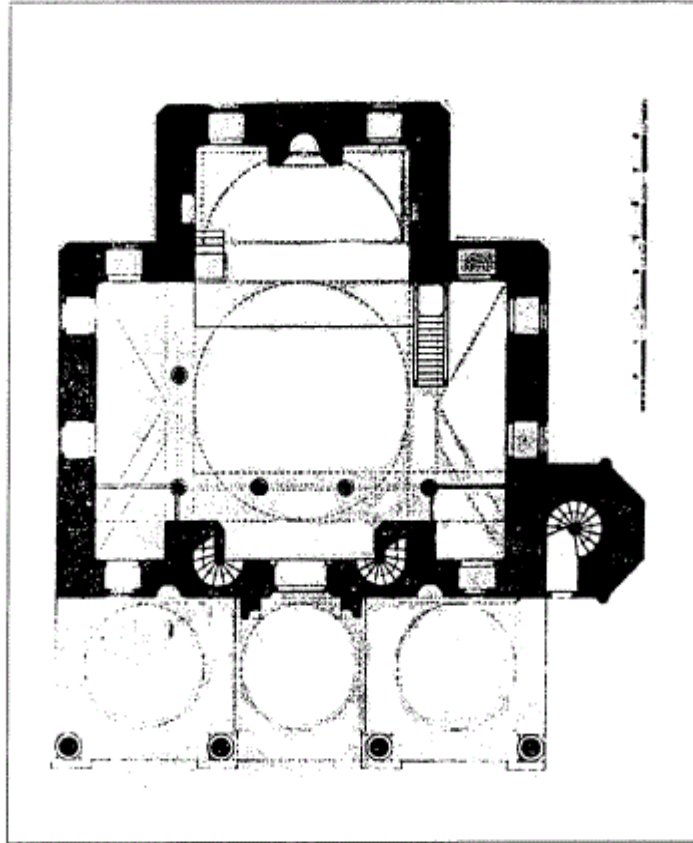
مسقط أفقي لمسجد مسيح باشا في إستانبول (عن : عبد الحافظ) .
